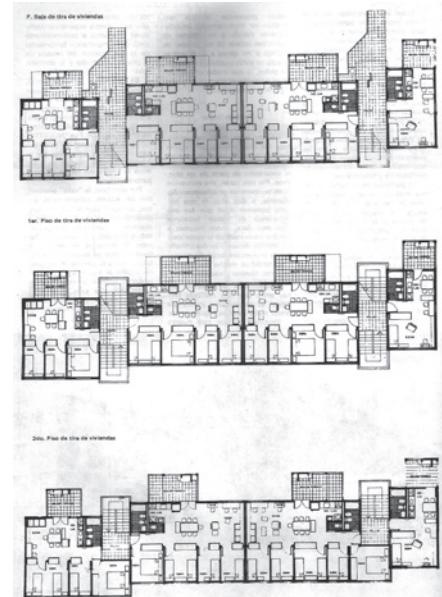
Planta de conjunto, Barrio Justo Suárez. Fuente: Trama, Revista de Arquitectura, Año 2, N.º 3, marzo de 1982. De acuerdo con el equipo técnico que desarrolló el Plan Piloto para el Realojamiento de Villa 7, "La unificación de los ambientes cocina-comedor-estar y la eliminación de los pasillos de circulación (que pueden ser recreados con elementos móviles) permite extraer un máximo de rendimiento dentro de los coeficientes de superficie utilizados". Fuente: Trama, Revista de Arquitectura, Año 2, N.º 3, marzo de 1982.
